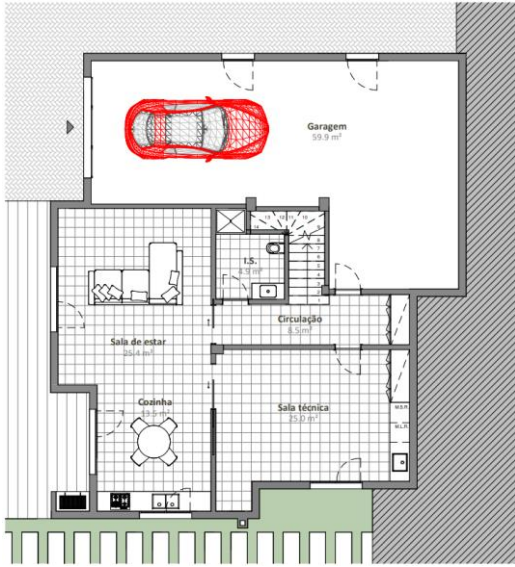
Proposto - Planta da cave (EP_R01). Fonte: Garq / Desenvolvimento: Autora.
